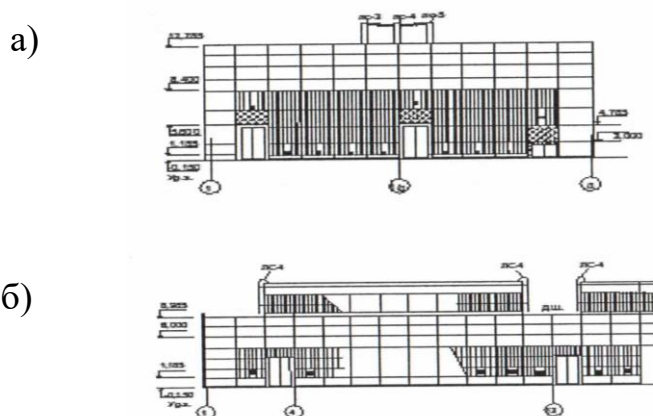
Примеры графического оформления фасадов одноэтажного промышленного здания:
